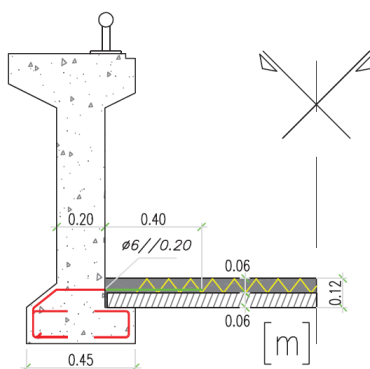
Pormenor de selagem da pré-laje às vigas pré-fabricadas [33].
